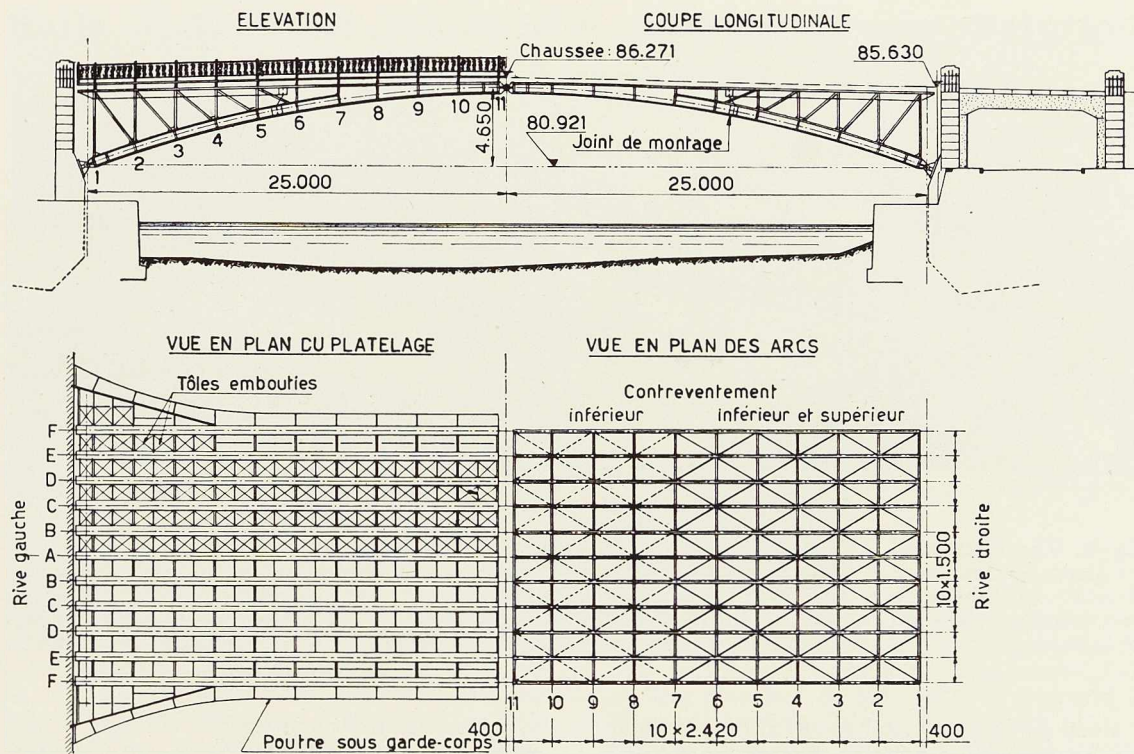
Elévation et vue en plan du pont de France à Namur.
